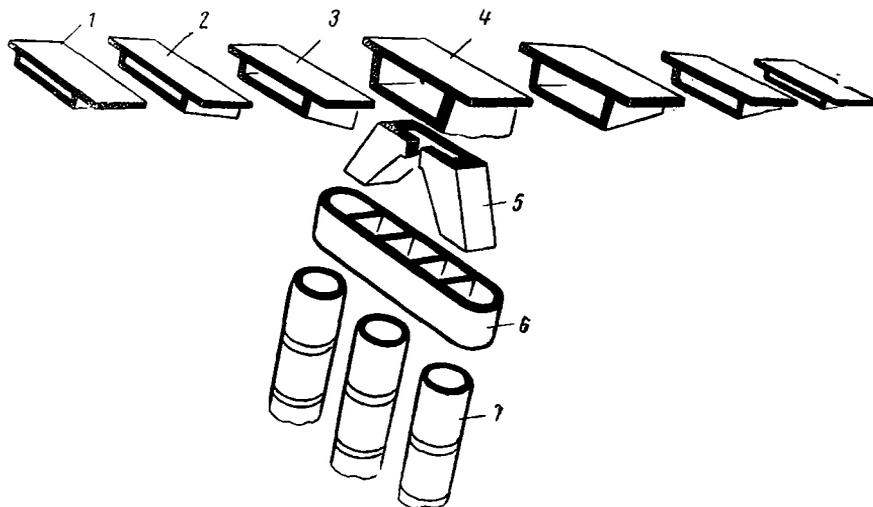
Элементы сборной конструкции опор и пролетных строений моста: 1 — блок пролетного строения массой 190 т; 2 — то же, массой 225 т; 3 — то же, массой 275 т; 4 — то же, массой 600 т; 5 — надфундаментная часть опоры; 6 — ростверк; 7 — облочка фундамента
